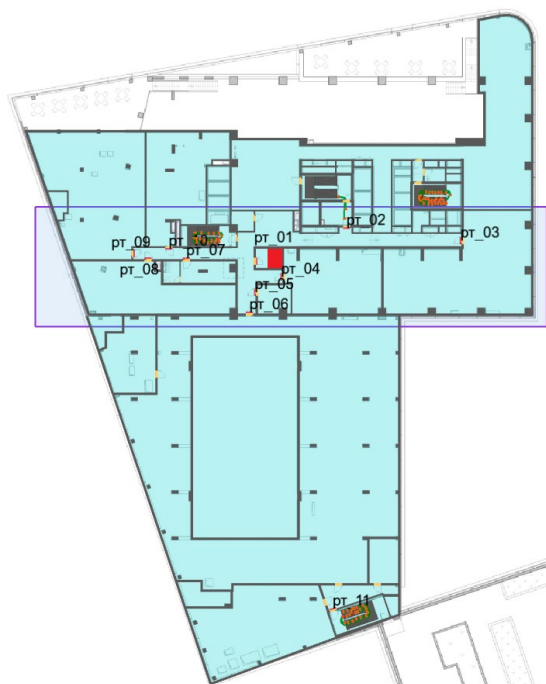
План 2-го этажа и нанесенная на него расчетная (принципиальная) схема эвакуации (расположение людей на момент полной эвакуации с этажа пожара – 1 мин. 19 сек.)
